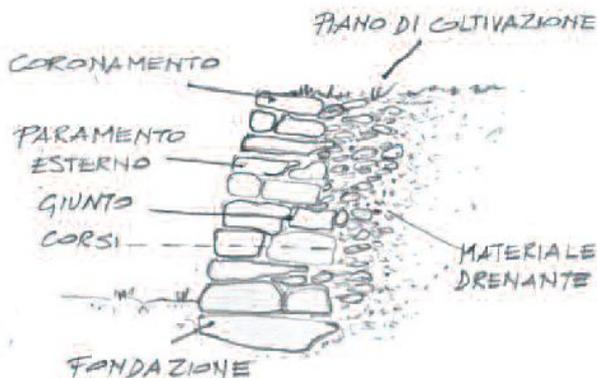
Sezione tipo muretto a secco (terrazzamento)
